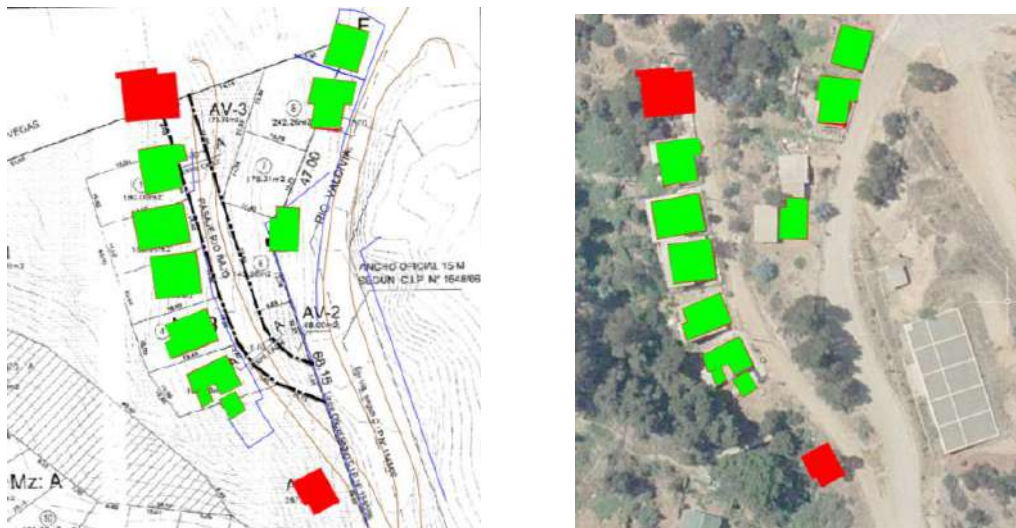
Plano de Levantamiento topográfico y emplazamiento de construcciones, Pasaje Rio Bajo, Sector Loteo Rio Valdivia, Chorrillos.
